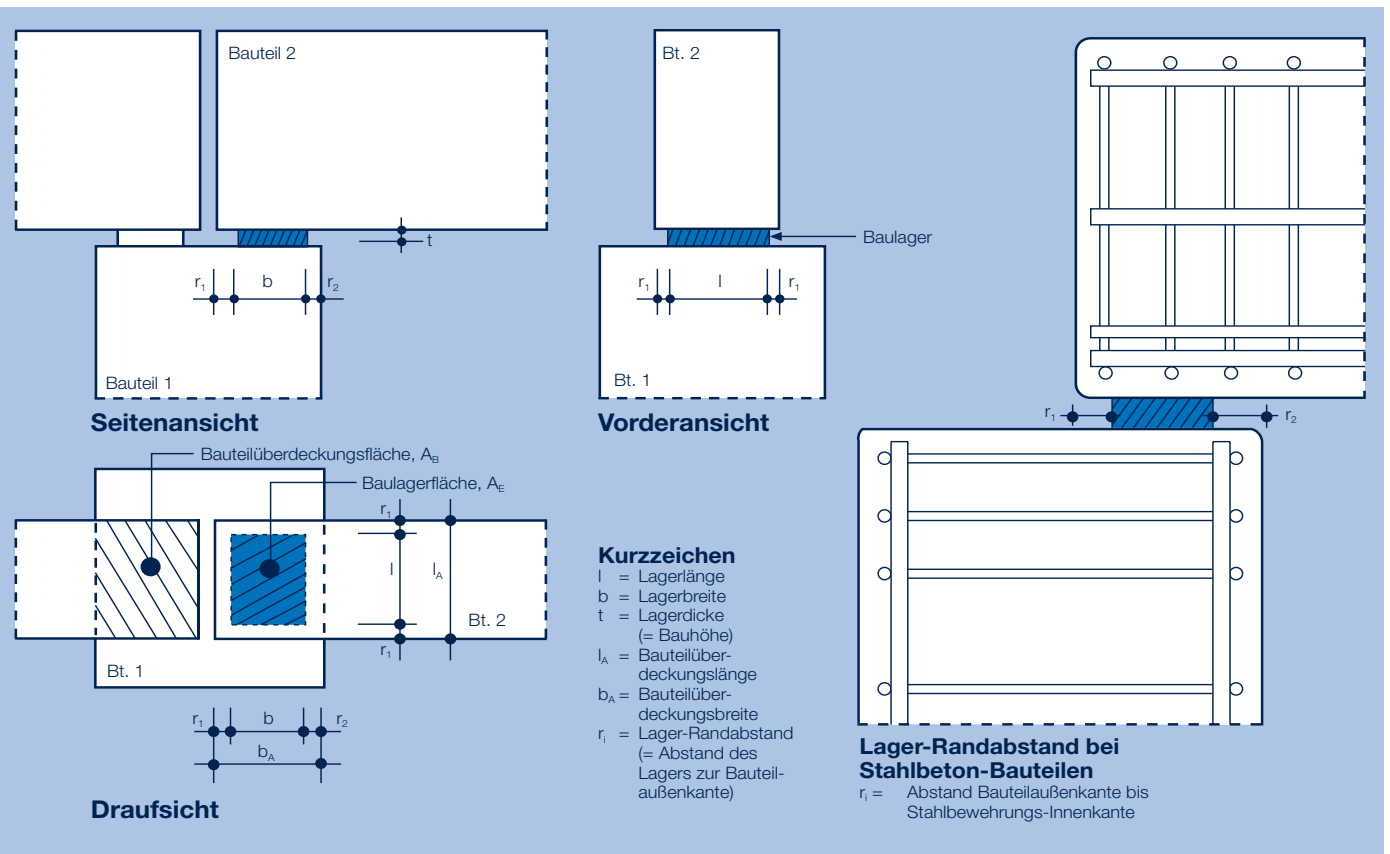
Maximale Größe der Grundrissfläche eines Elastomerlagers im Stahlbetonbau (Randabstand). Bei Bauteilen aus Holz oder Stahl sollte der Randabstand des Elastomerlagers mindestens 3 cm bzw. den 1,5fachen Wert der Lagerdicke haben.
